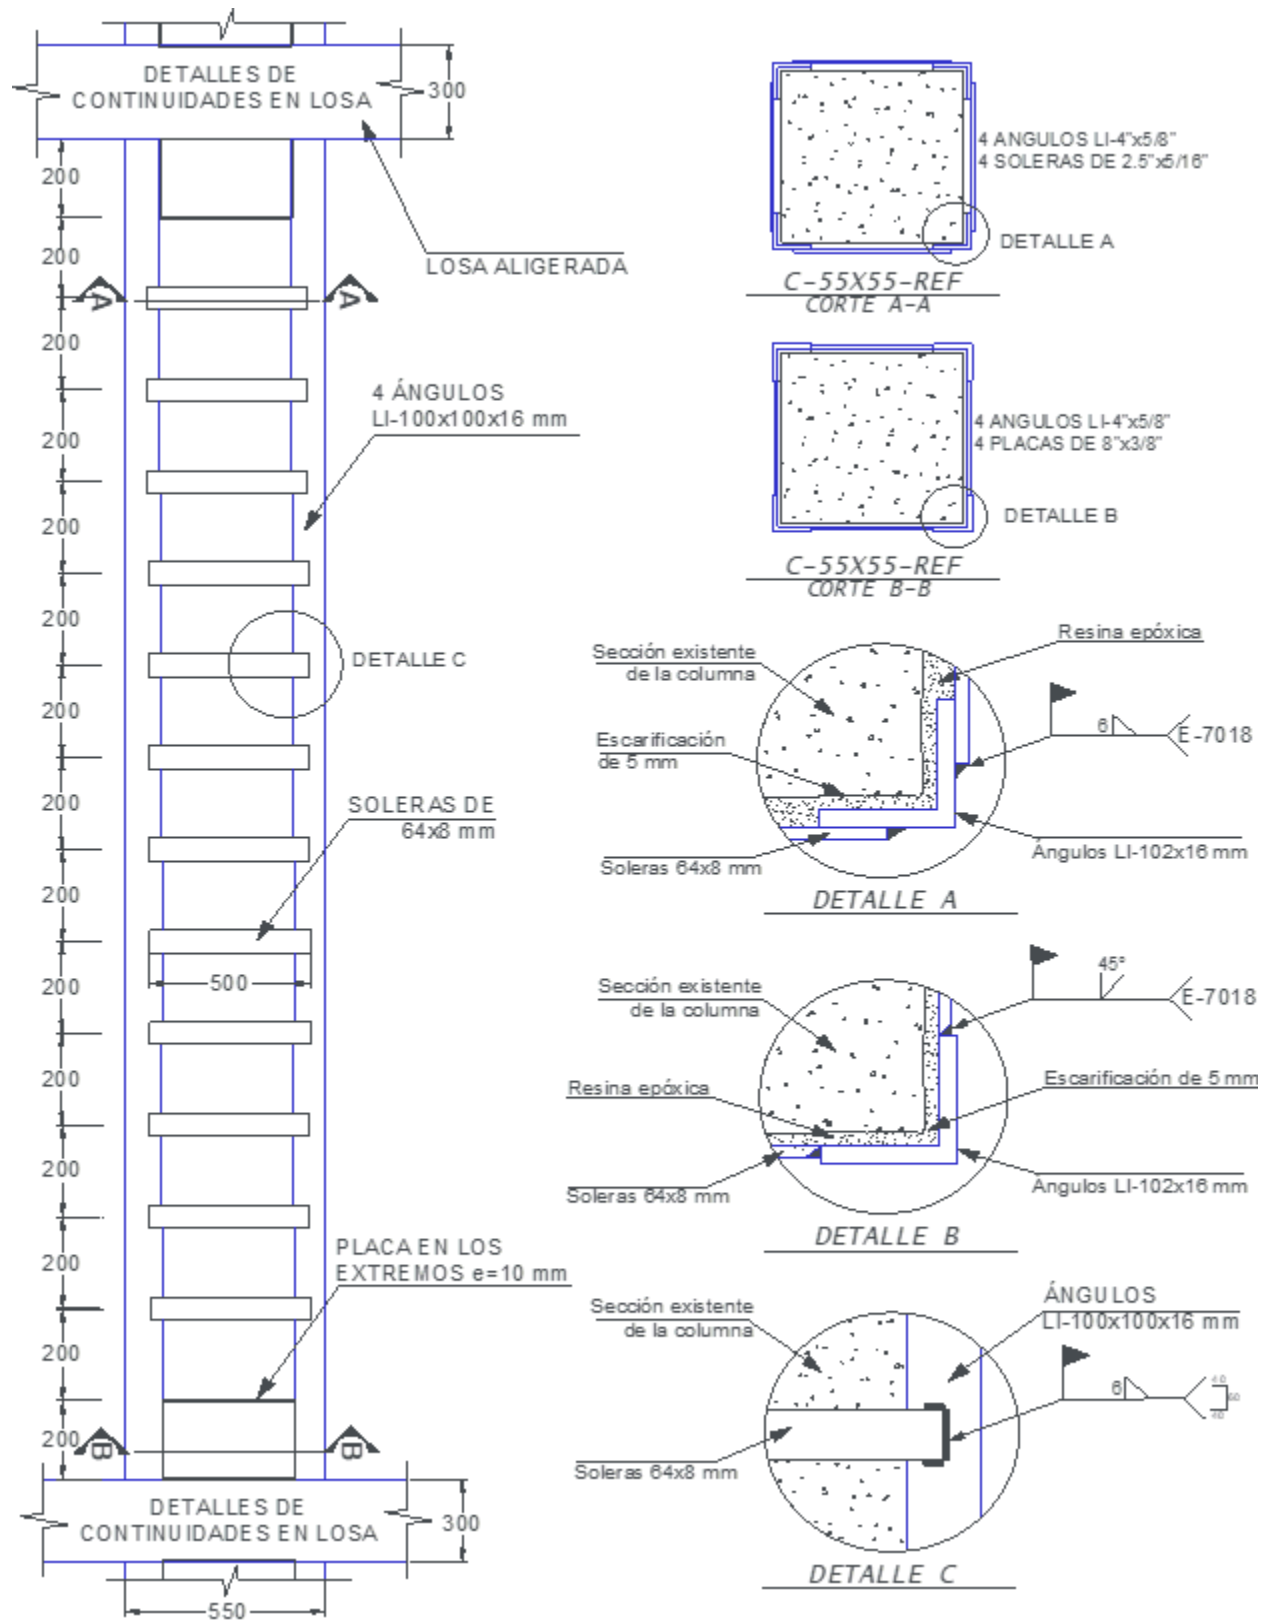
Armado y detalles de la columna reforzada con angulos, soleras y placas.
